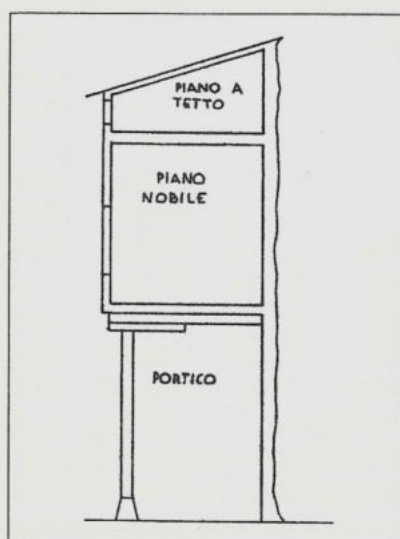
Sezione della «casa tipo» bolognese, con portico. Si possono notare le soluzioni scelte per impedire il passaggio dell'acqua piovana sul tavolato del solaio, tramite l'aggetto sulla strada. Per difenderlo poi dalle infiltrazioni provenienti dai pavimenti in mattoni, lavati ad acqua, si provvede con un rivestimento in arelle intonacate.
